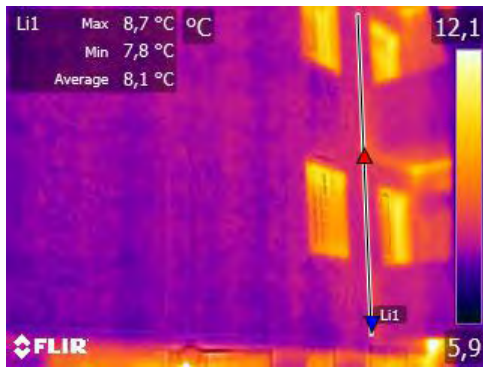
MCA\_6: condizioni di rilevazione passiva, fascia oraria 18-19. Prospetto ovest.
